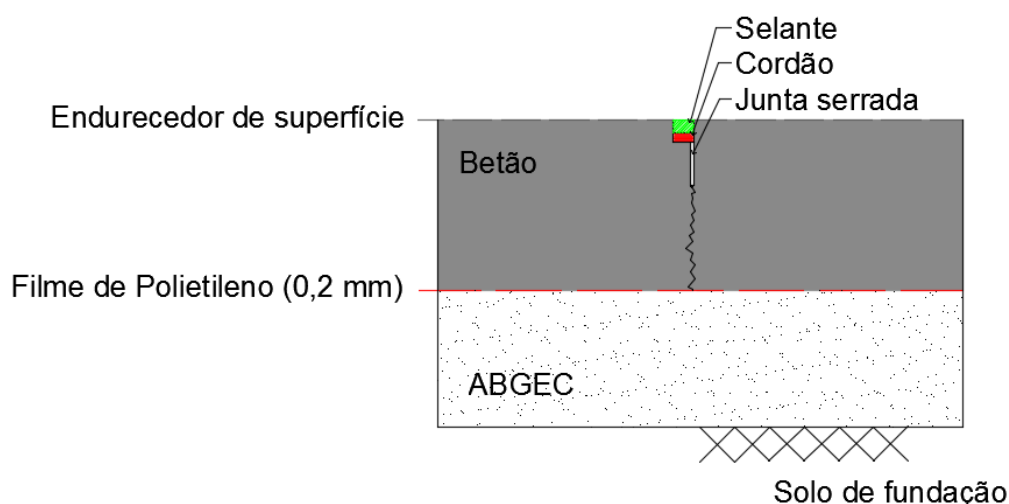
Exemplo de um perfil de pavimento rígido simples
